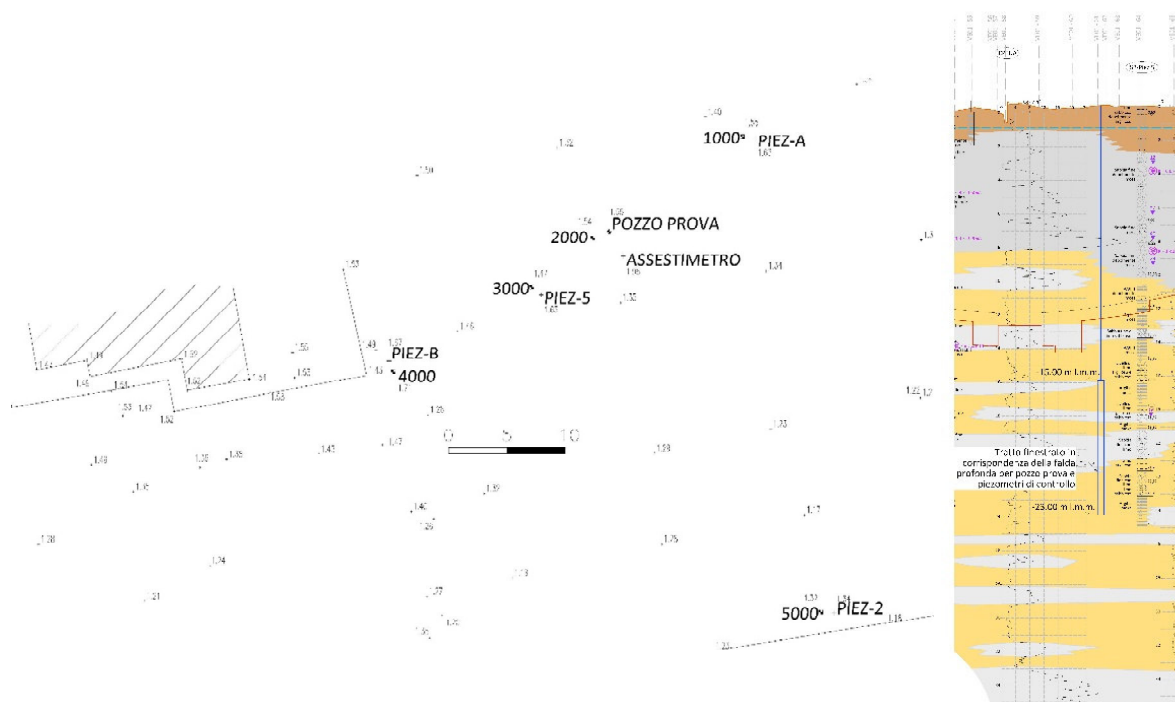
Planimetria con ubicazione del pozzo e dei piezometri di controllo e posizionamento dei tratti finestrati rispetto alla stratigrafia di progetto
